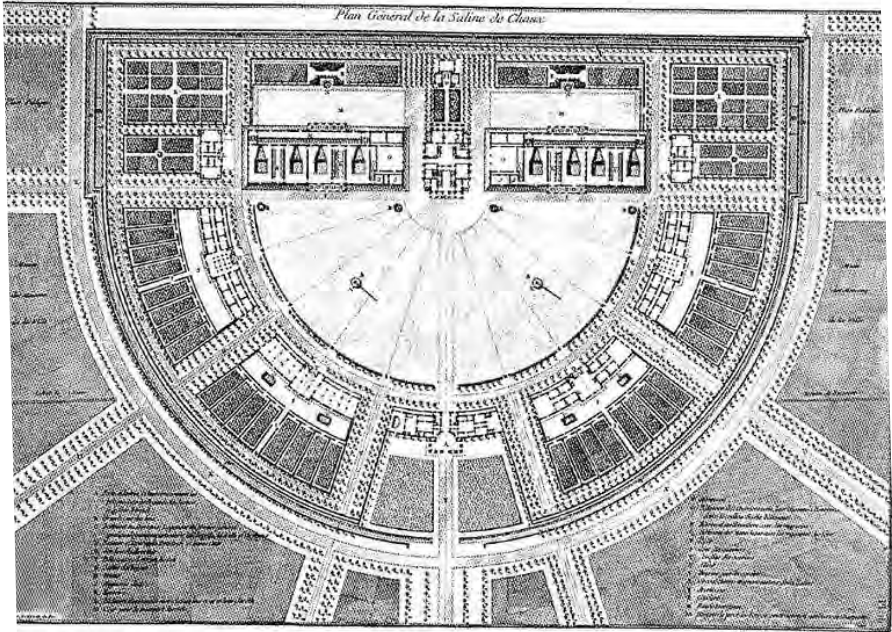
Plano de las Salinas Reales de Chaux C.N. Ledoux 1775-1779. Fuente. Pág. 56, Darley, Gillian (2010) La fábrica como arquitectura: facetas de la construcción industrial. Barcelona. Editorial Reverté.
